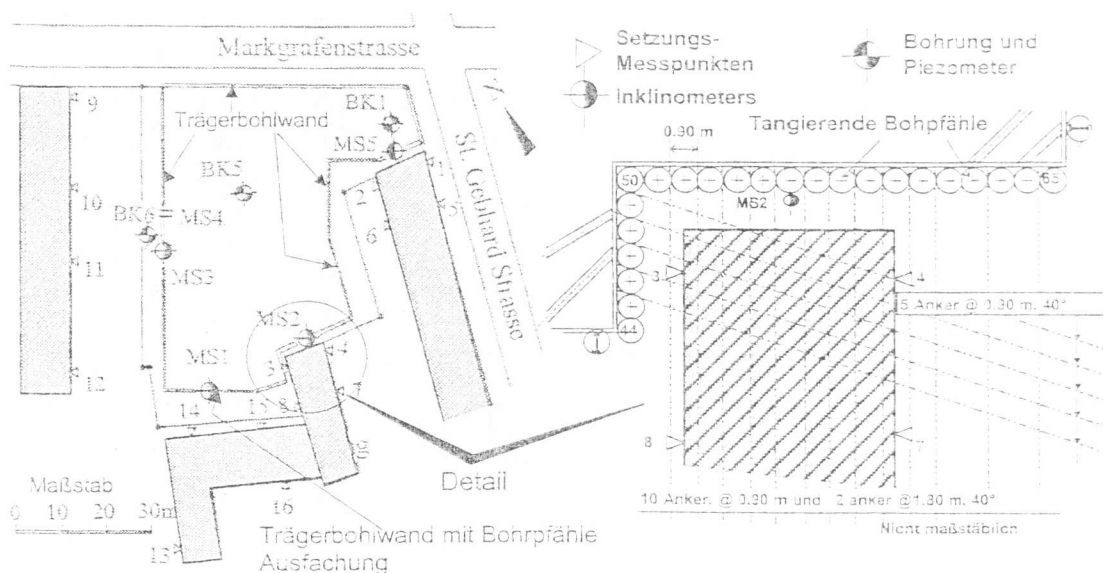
Grundriss der Baugrube und mit Hauptmessungen und Bohrungen, Projekt II
